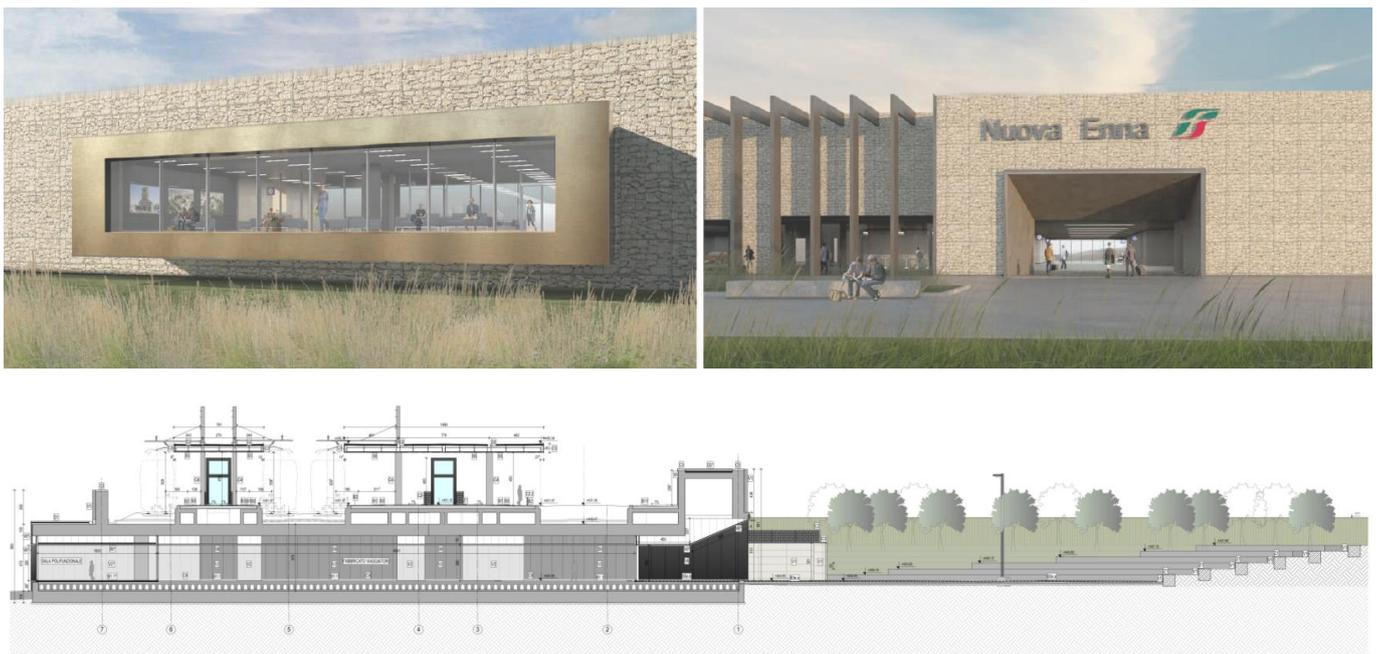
Sezione Longitudinale Stazione Nuova Enna dall'Agorà alla vetrata panoramica
